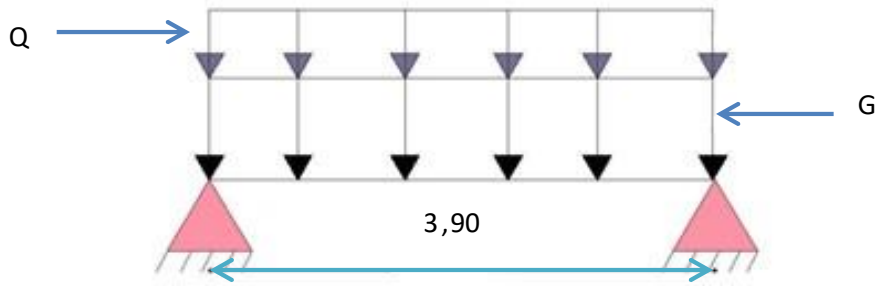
Schéma statique d'une poutrelle isostatique.
